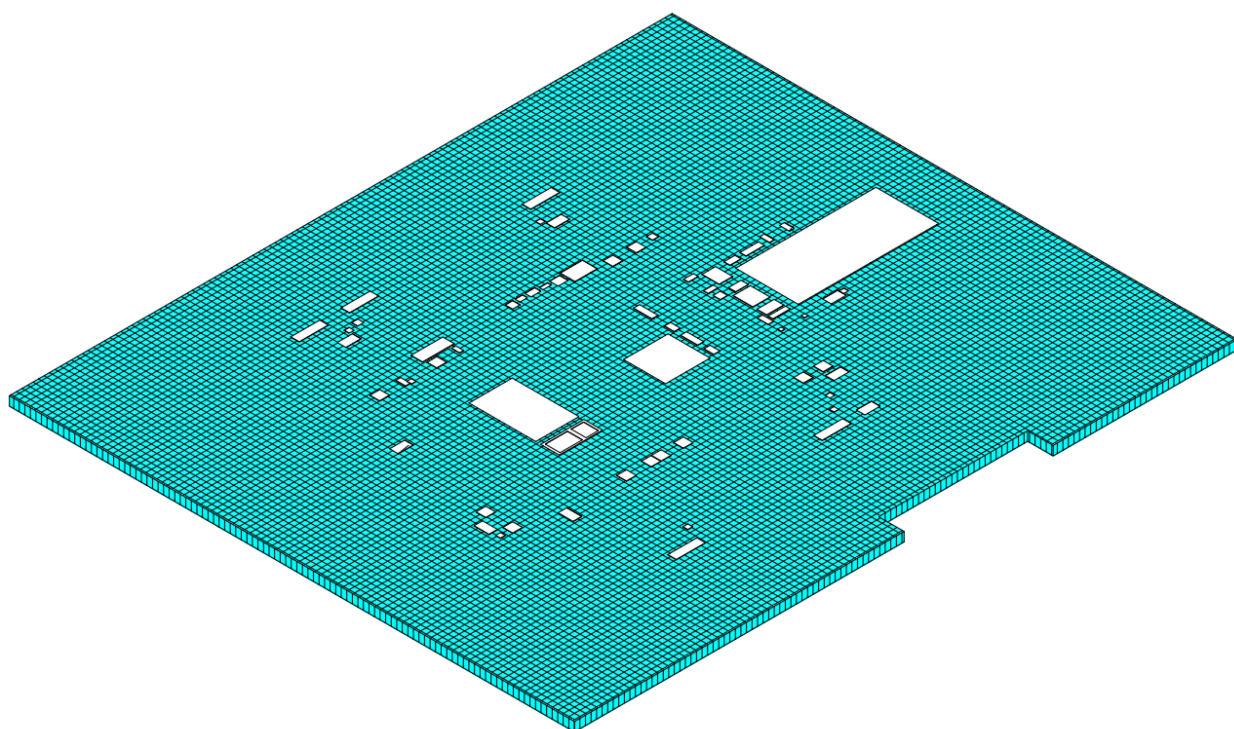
Расчетная схема (для рассматриваемого перекрытия)
